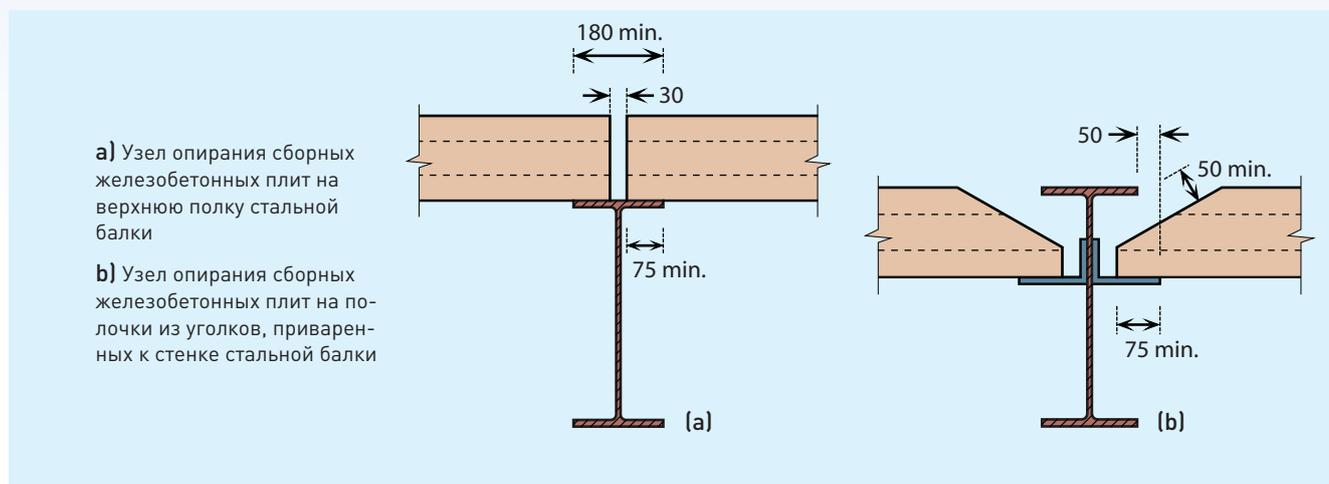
Узлы опирания сборных железобетонных плит на стальные балки в некомпозитных перекрытиях
